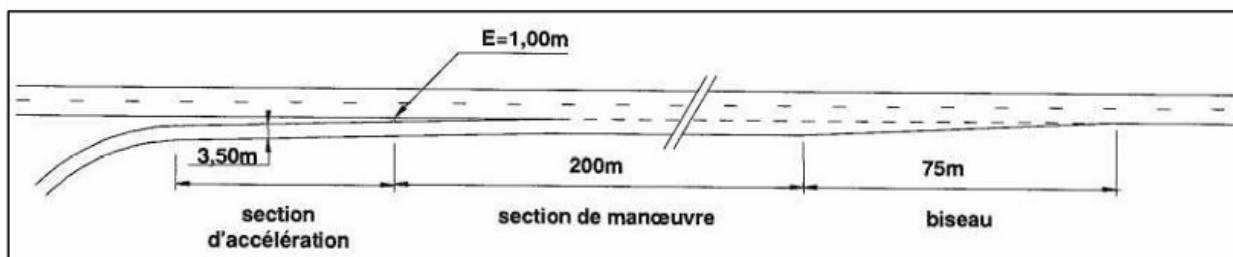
Dispositif d'entrée sur l'autoroute
